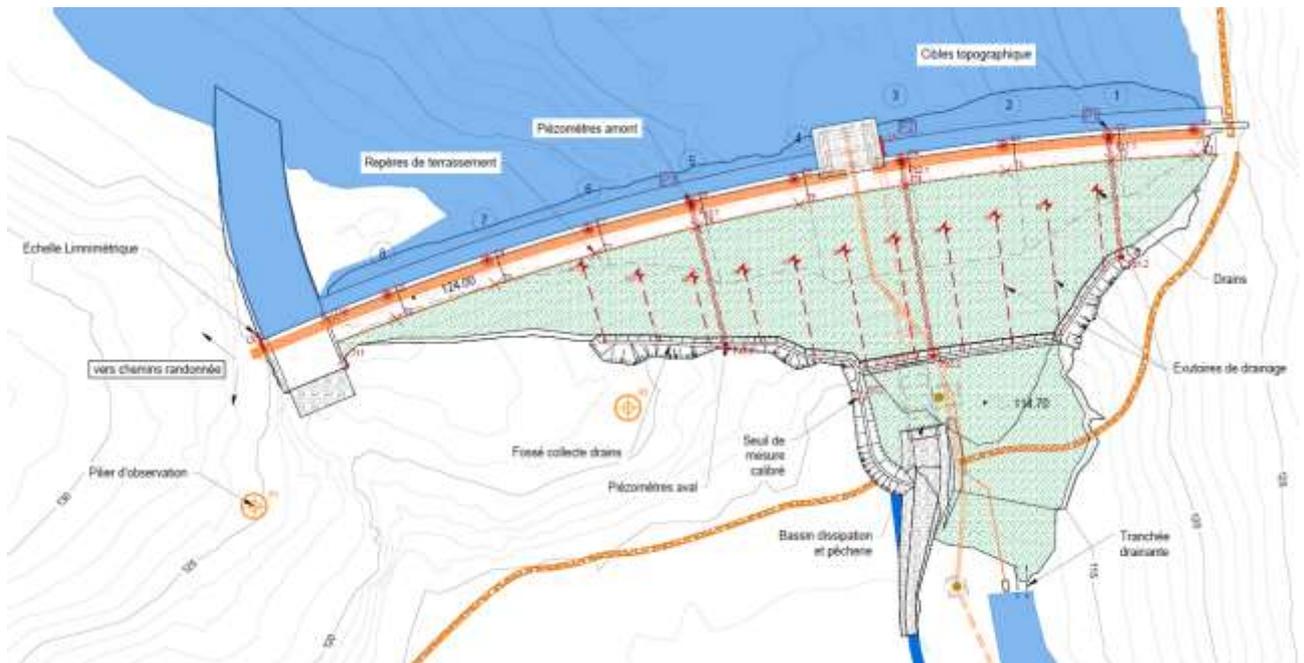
Vue en plan du dispositif d'auscultation du barrage (plan AUSC-01)
